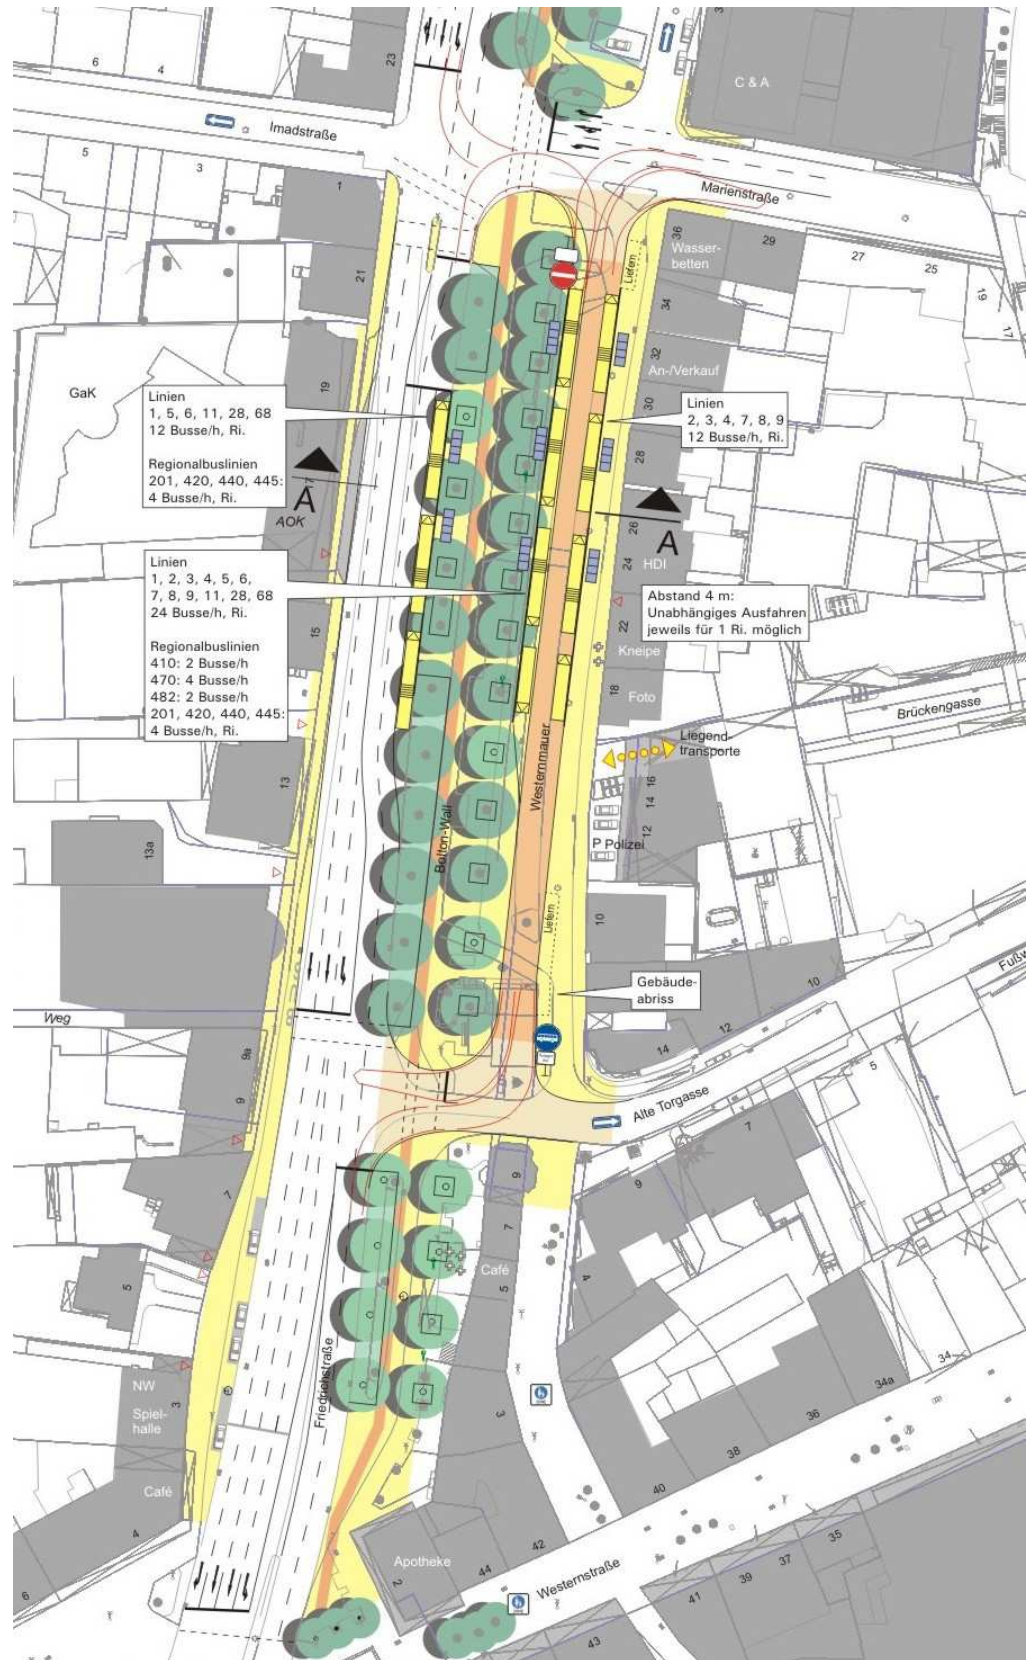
Variante 1 (bestandsorientiert) der ZOH Westernmauer im Lageplan
